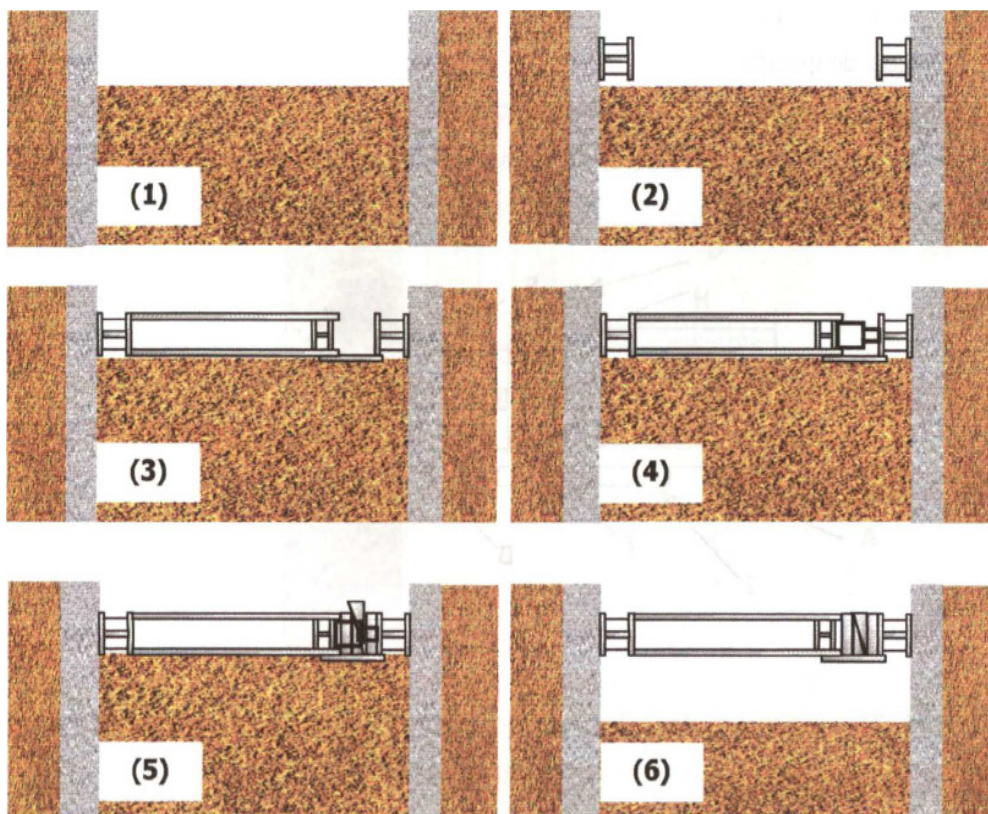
Faseamento de aplicação do pré-esforço no sistema tradicional (Pinto, 2008)
